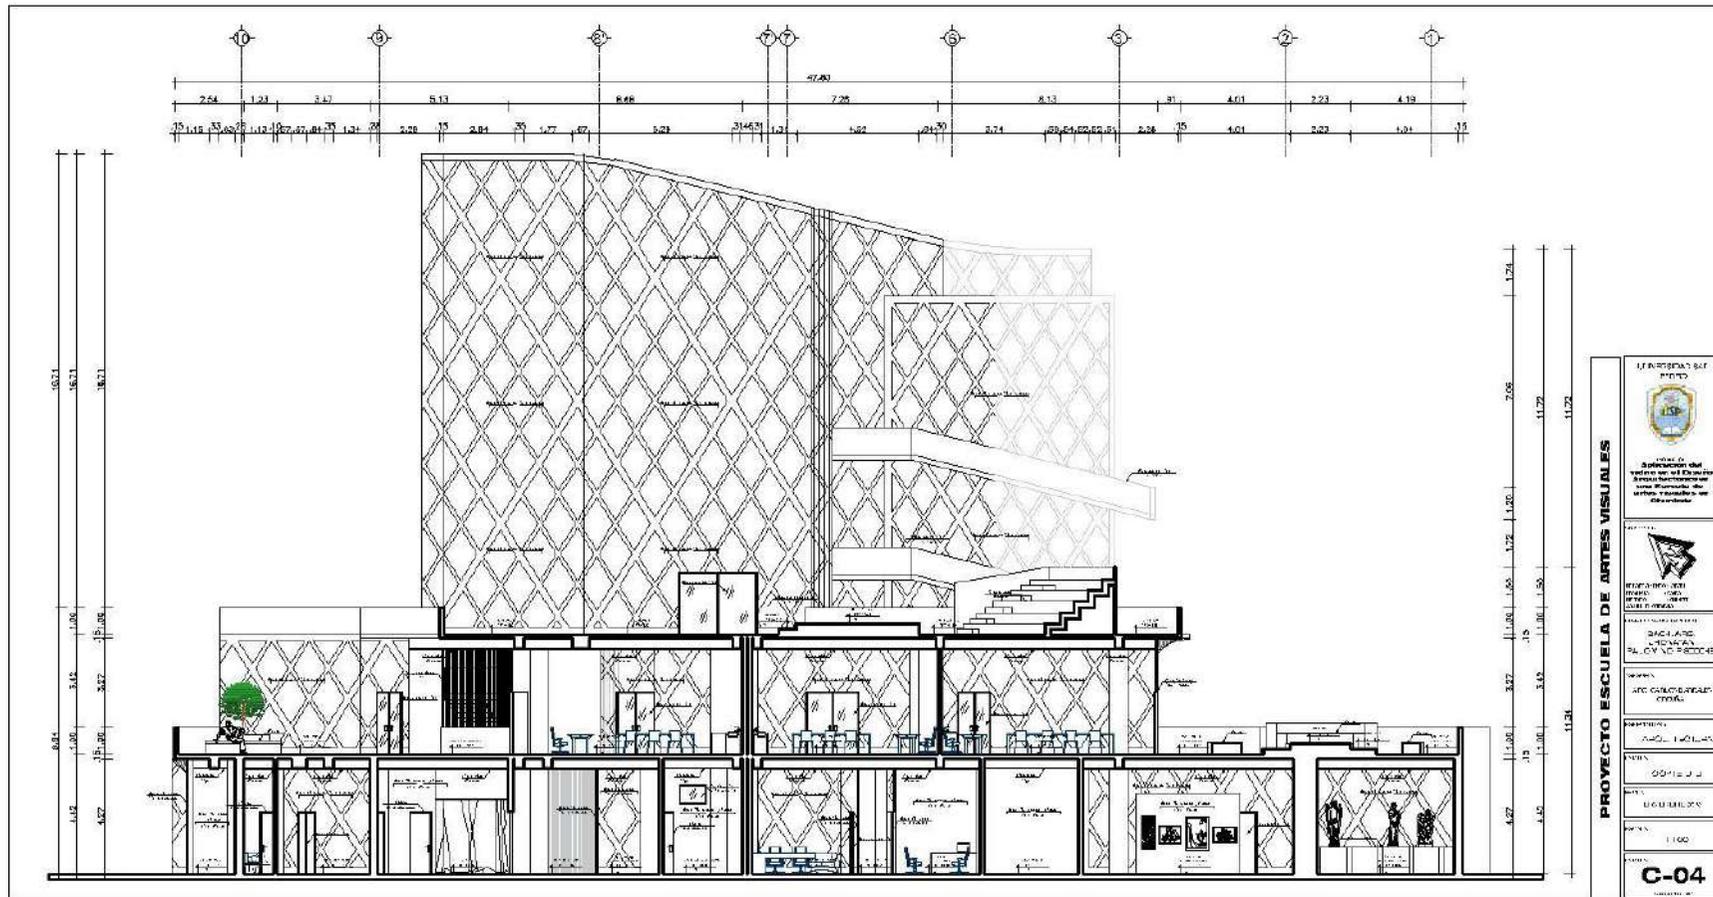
Plano de Corte D-D del Proyecto Arquitectónico
